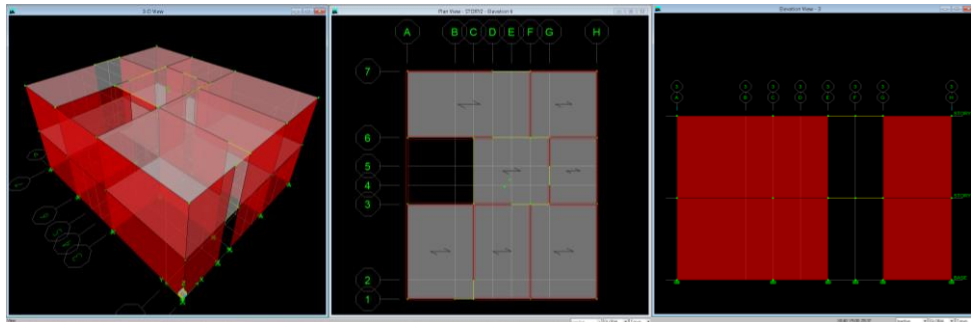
Vista en planta y elevación del modelamiento de la edificación 1
